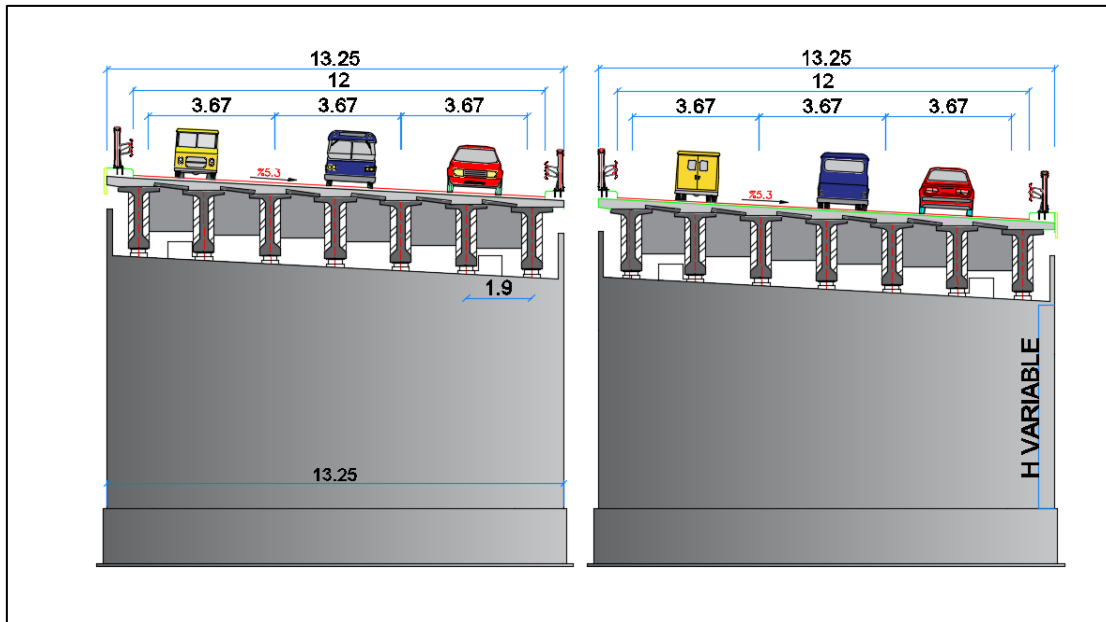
Coupe transversale sur culée VARIANTE 01
